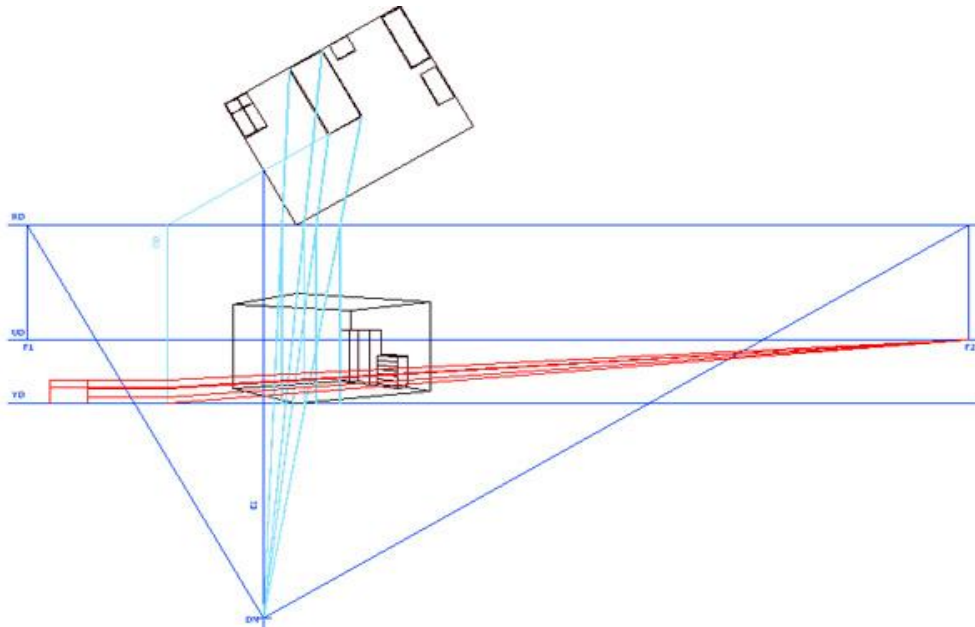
Resim düzlemini kesen ışınların yer düzlemine taşınması
